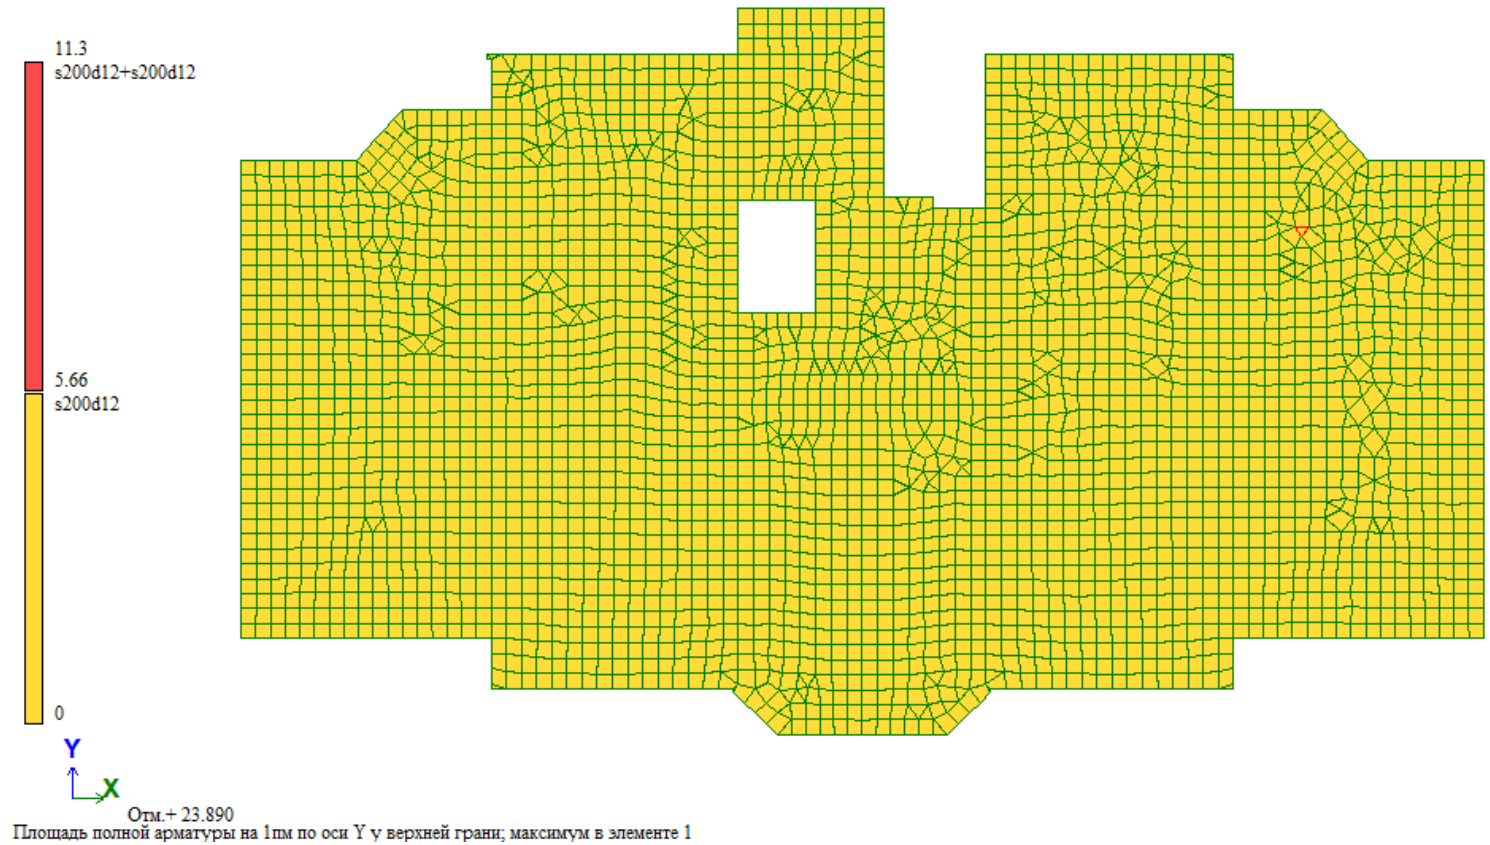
Площадь арматуры на 1пм по Y у верхней грани
